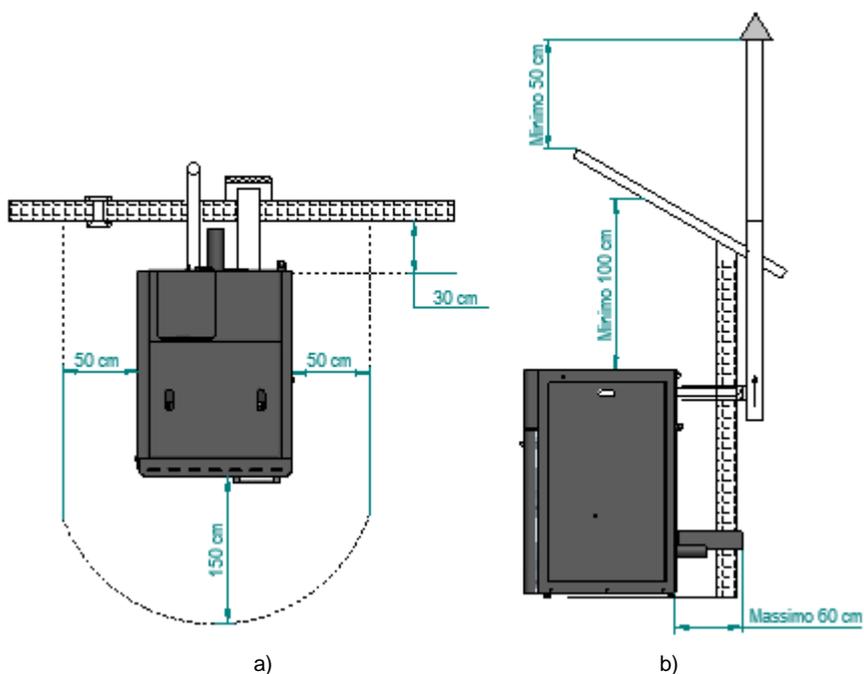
Distanze minime da tutte le superfici: a) vista dall'alto dell'installazione dell'apparecchio; b) vista laterale dell'installazione dell'apparecchio
